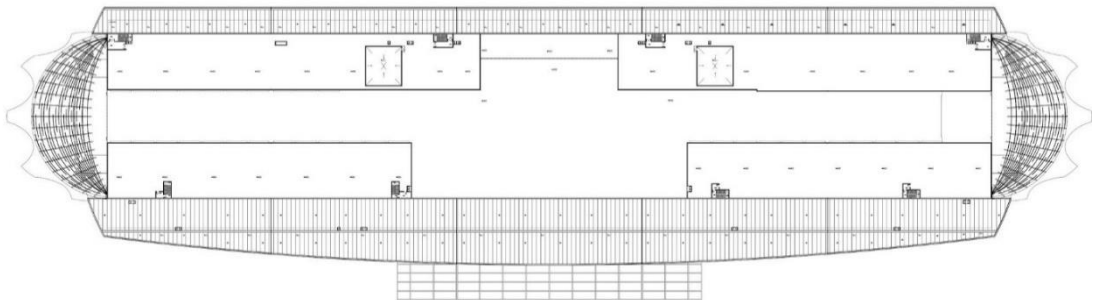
Ankara yüksek hızlı tren garı 3. kat planı (URL-11)
